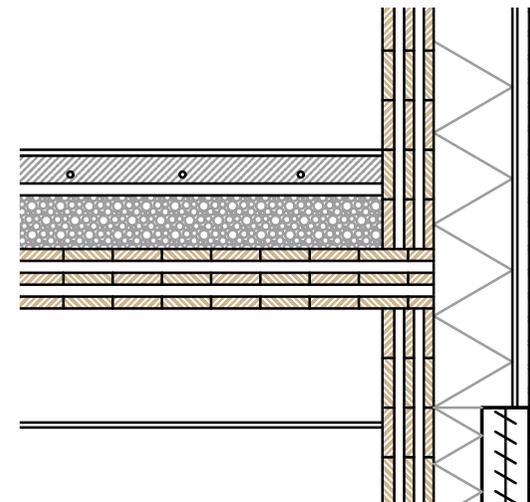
Wandaufbau im Deckenanschlussbereich
